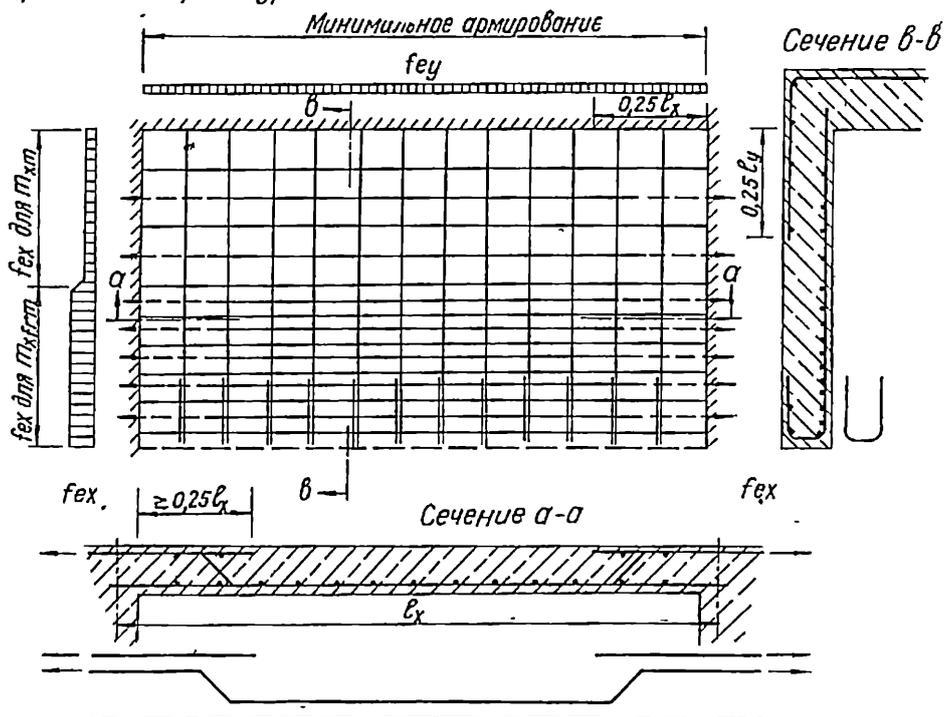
27. Армирование плит, свободно опертых по трем сторонам с одним свободным краем (для равномерно распределенной нагрузки)
